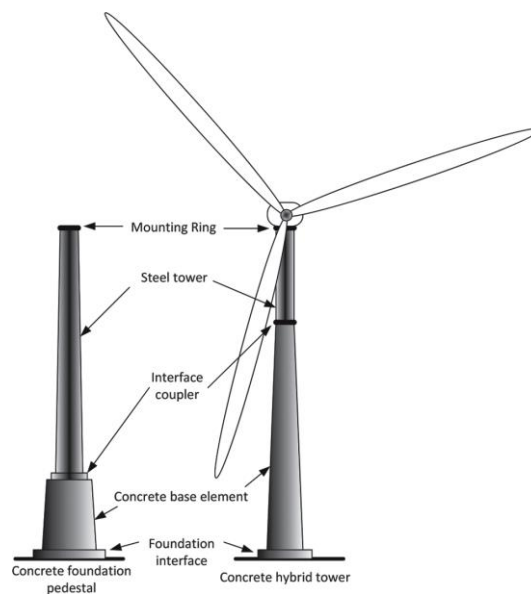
Torre híbrida de hormigón (Fuente ACI ITG 9)
